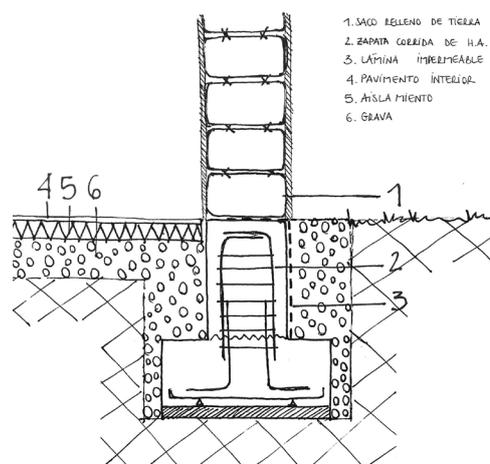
Detalle de cimentación con zapata perimetral de hormigón. Elaboración propia.
